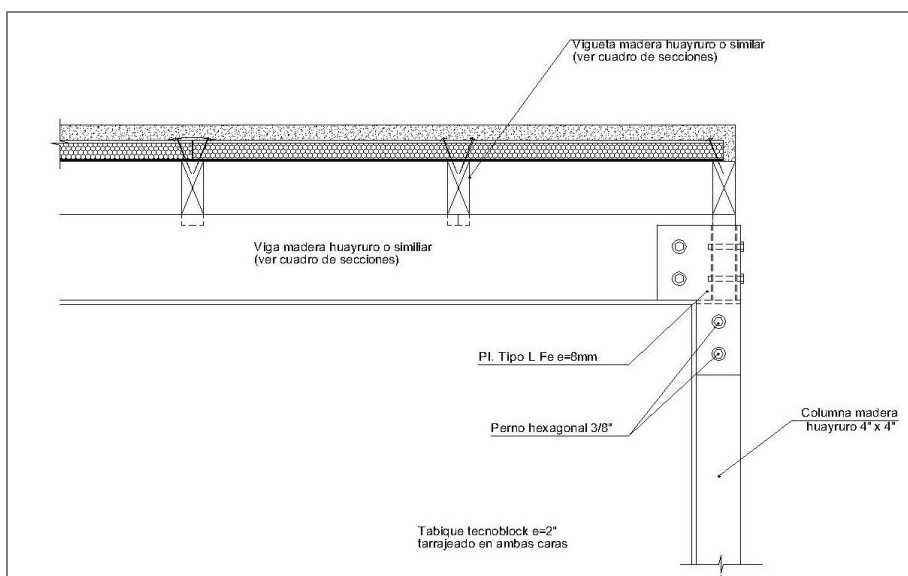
Detalle de fijación con platina de vigas y columna en esquina
